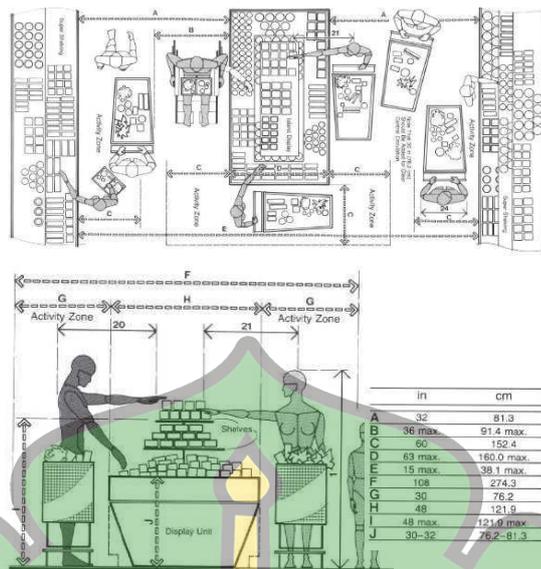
3 Standar Ruang Untuk Pengguna Alat Bantu Jalan
